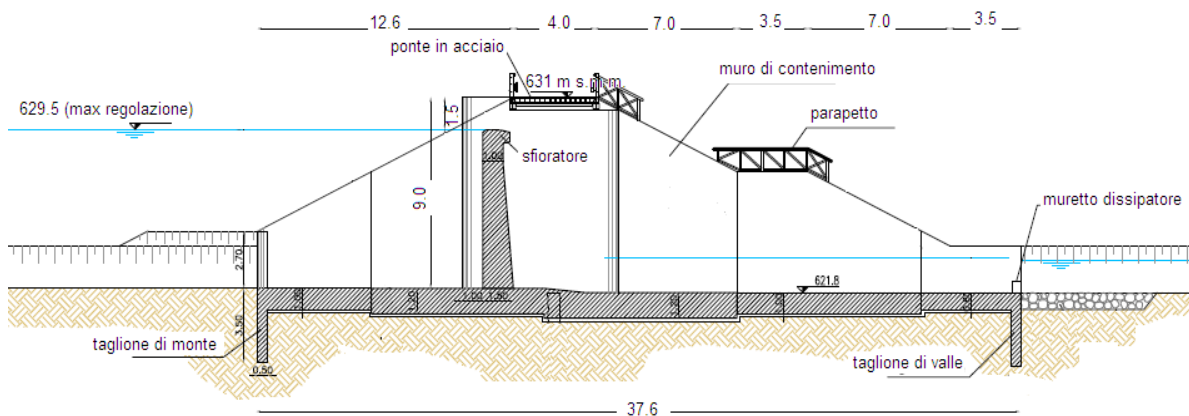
Sezione longitudinale della traversa di regolazione. Cassa sul T. Vallemura.
